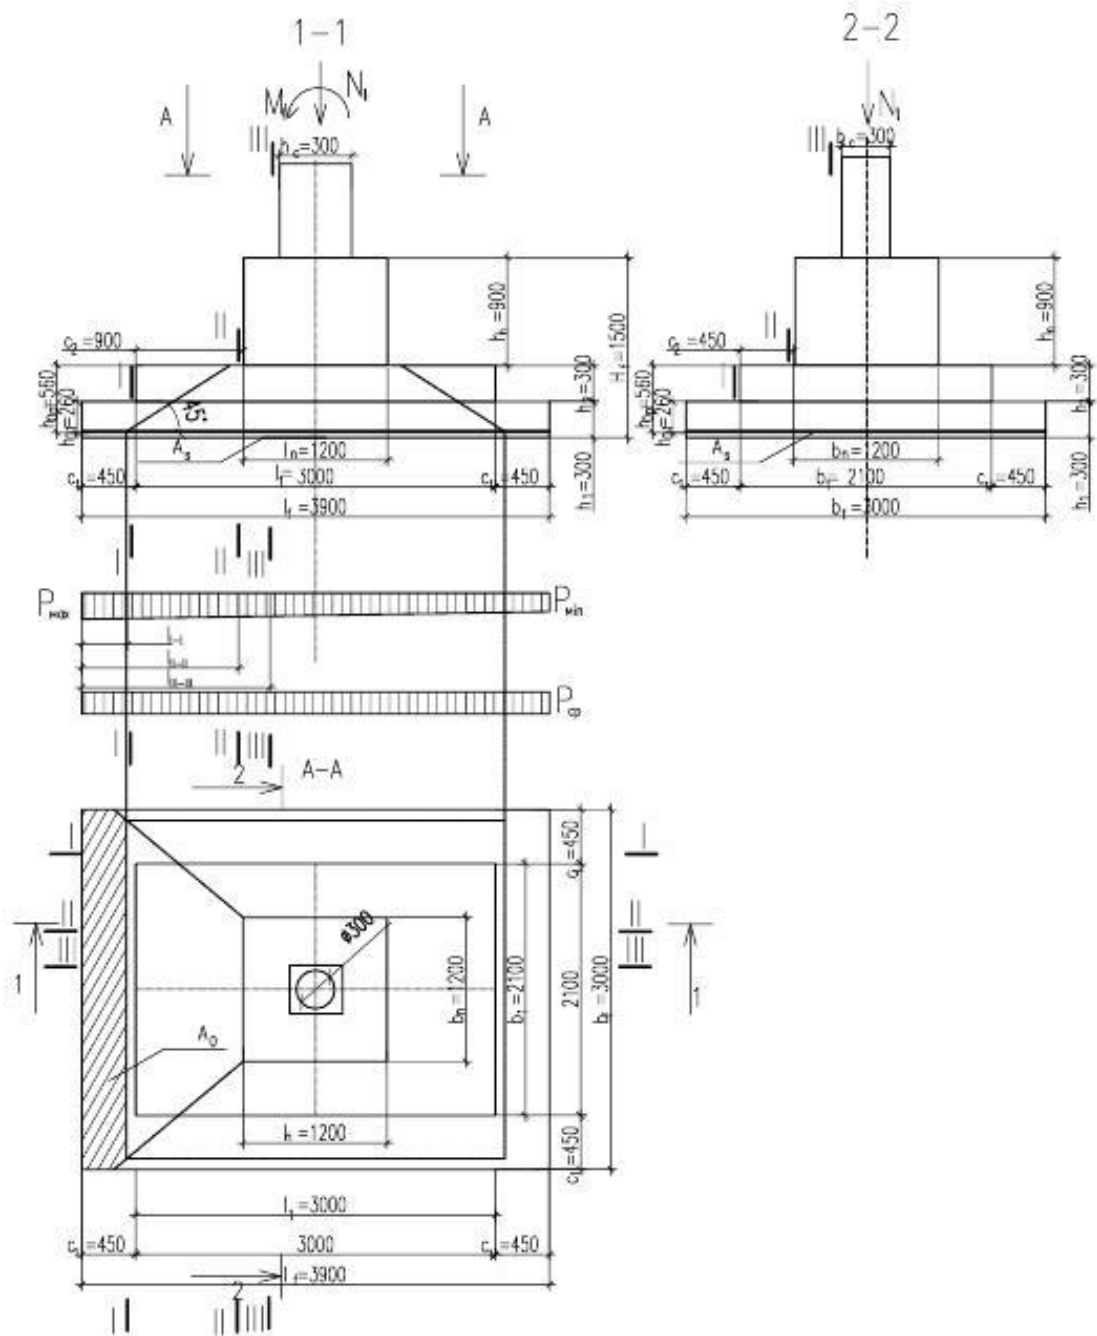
К определению высоты фундамента, конструирование фундамента и к расчету прочности плитной части на продавливание
